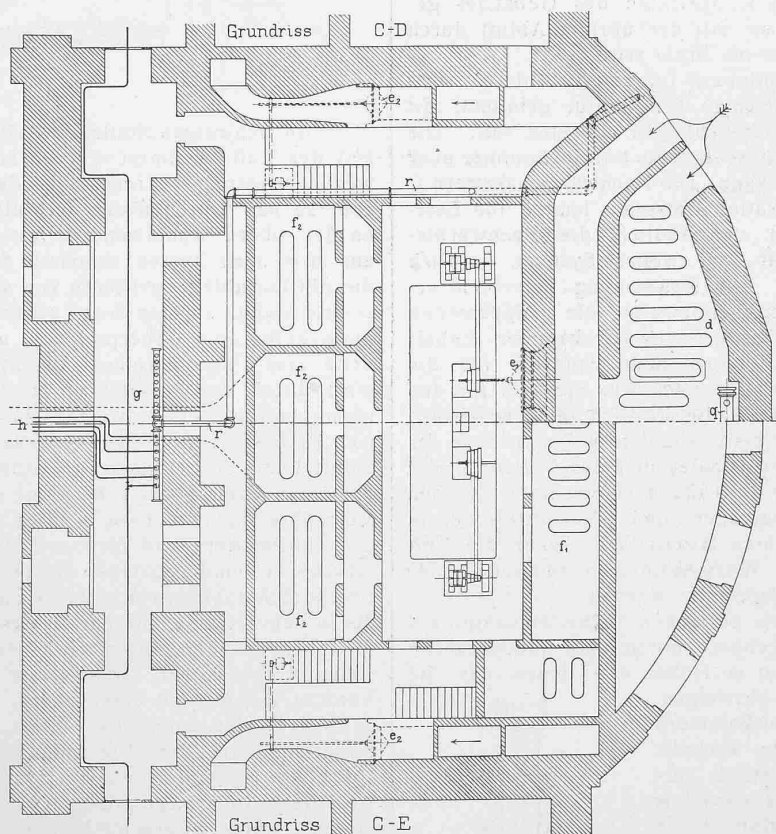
Heizkammern und zentraler Regulierungsraum. — Grundrisse. — 1:250.
